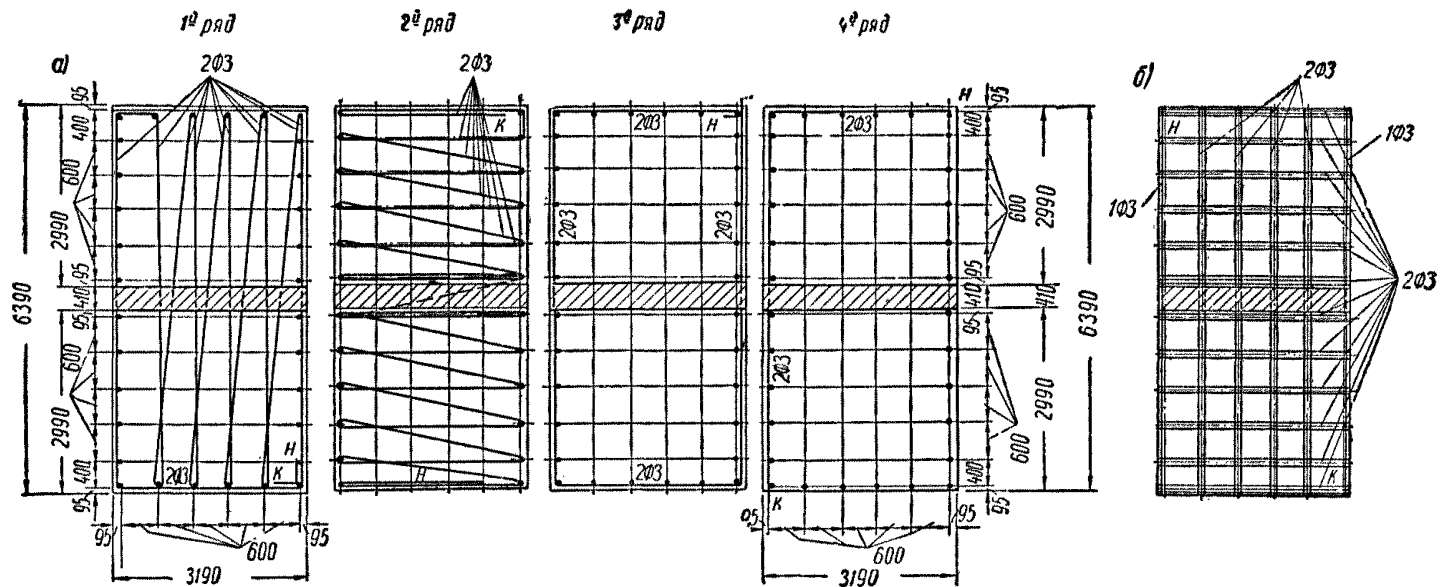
Схема очередности навивки арматуры и места крепления ее концов в железобетонной панели междуэтажного перекрытия
